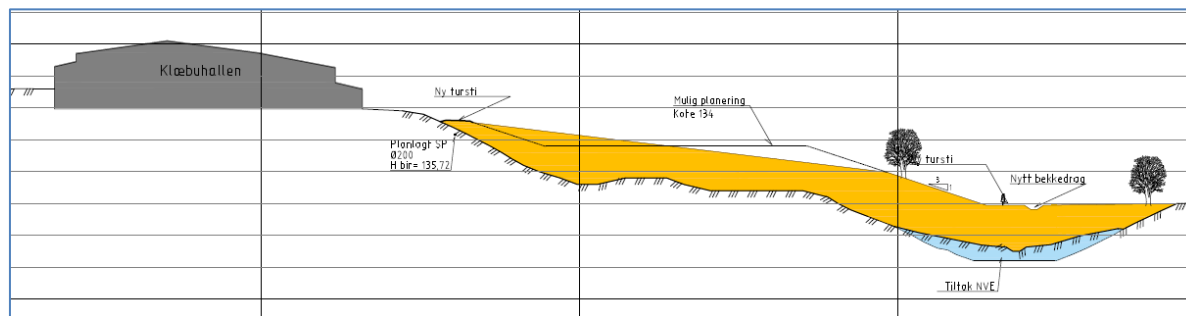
Snitt som viser planlagt terreng og terreng ved mulig planering. Snittene er vedlagt planforslaget.
